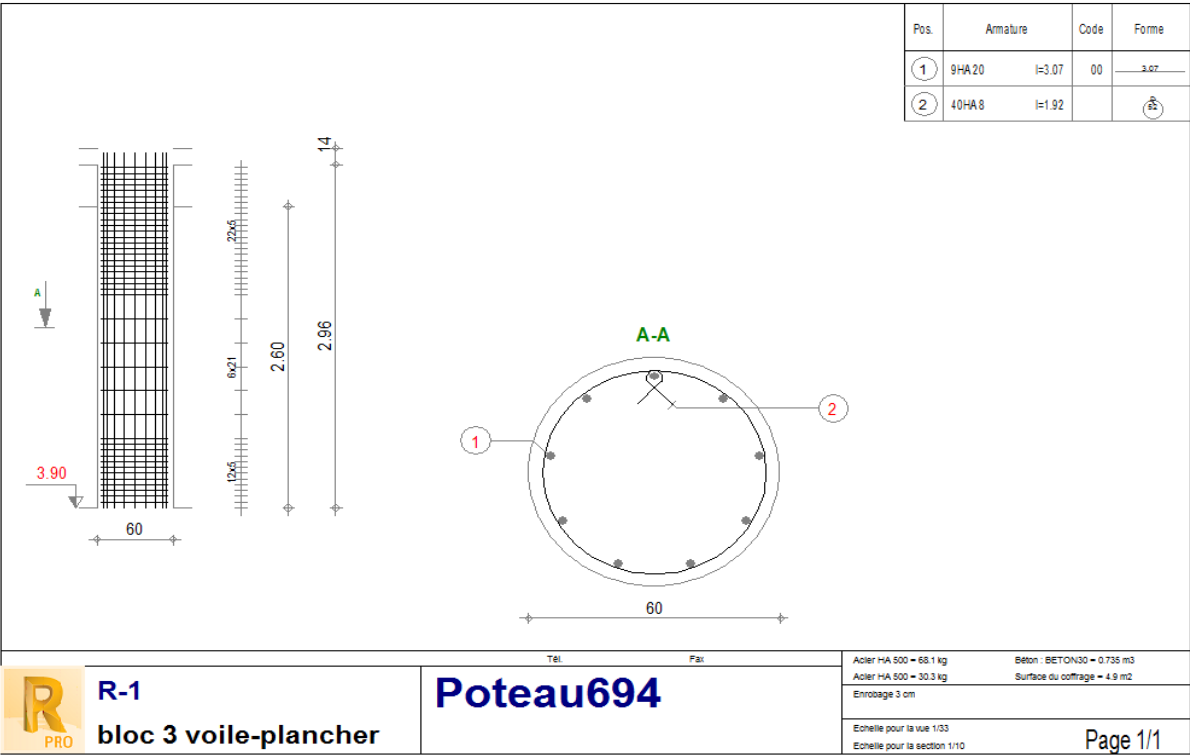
Ferrailage des Poteaux P60 et P61 (R-1 et RDC)
